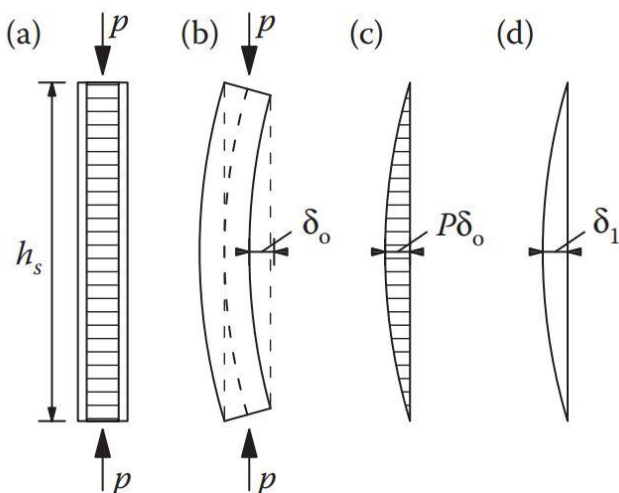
Deformimet që shkaktojnë duktilitet jashtë planit:
